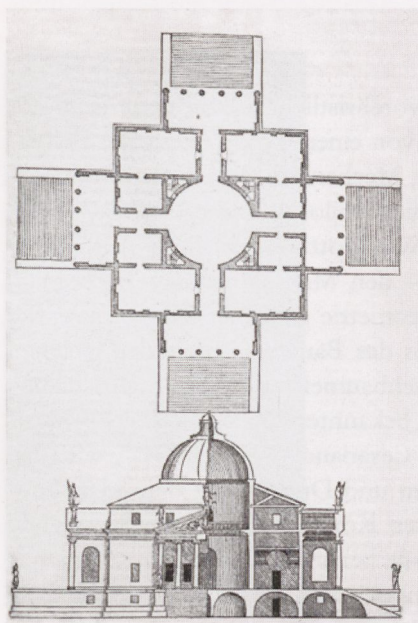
Andrea Palladio, Grundriss und Schnitt Villa Capra, nach 1552.
